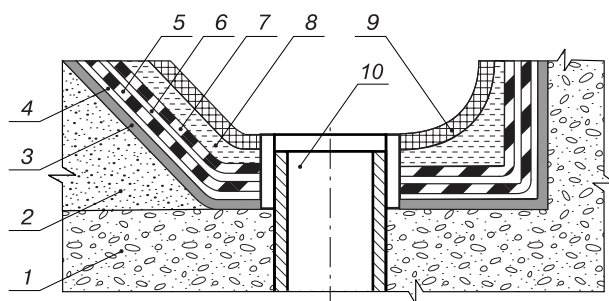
Гидроизоляция и декоративно-защитное покрытие пенного корытца в зоне водоотвода: 1 – старый бетон; 2 – штукатурный бортик; 3 – грунтовка Лукар-ОП; 4, 6 – Лукар-5; 5 – стеклоткань; 7 – стеклоткань утолщенная; 8 – Лукар-ОХ; 9 – декоративный Лукар-ОХ; 10 – водоотводная труба
